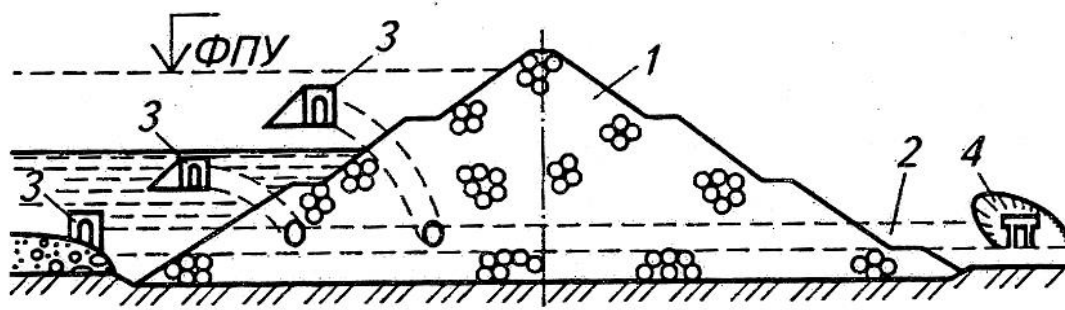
Каменно-набросная плотина и водосброс гидроузла селехранилища:
